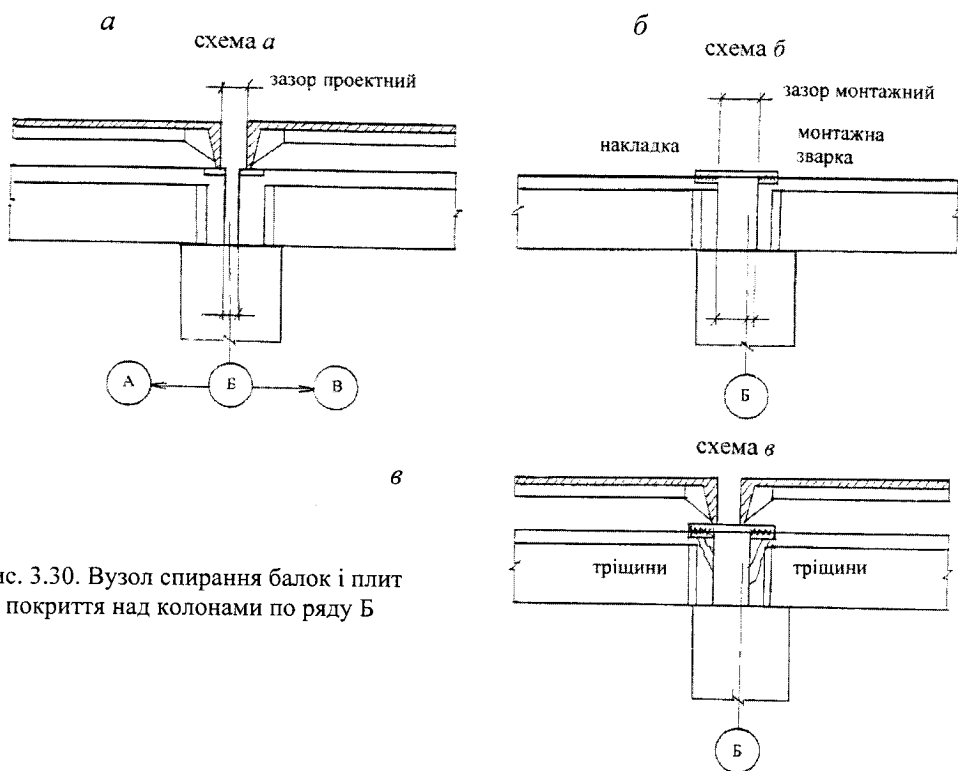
Вузол спирання балок і плит покриття над колонами по ряду Б
